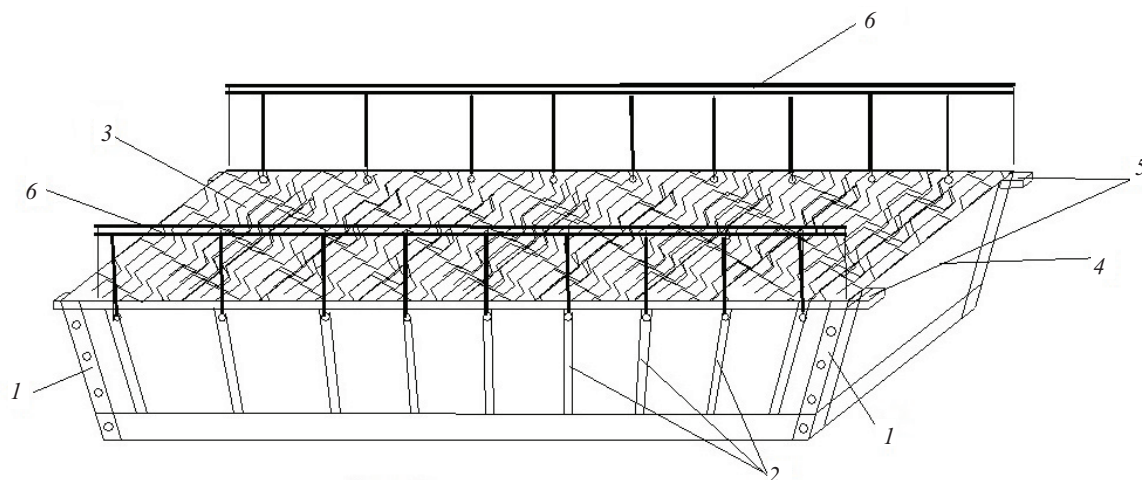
Полносборный корпус из композитного материала с установленным ортотропным покрытием и перилами: 1 — боковой специальный клапан, шивочный элемент внешнего корпуса с отверстиями, позволяющий дополнительно жестко стянуть корпус; 2 — специальные каналы, позволяющие после полной сборки установить в них ограждающее устройство с перилами; 3 — ортотропный элемент покрытия; 4 — полностью собранный внешний корпус; 5 — проушинное устройство для возможного соединения нескольких пролетов при устройстве понтонной переправы, или при транспортировке пролета к месту монтажа; 6 — внешнее ограждение с перилами
